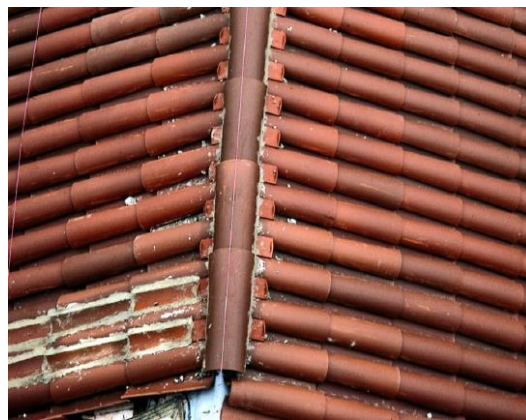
Vista das Passadeiras e Cumeeira com argamassa pobre
